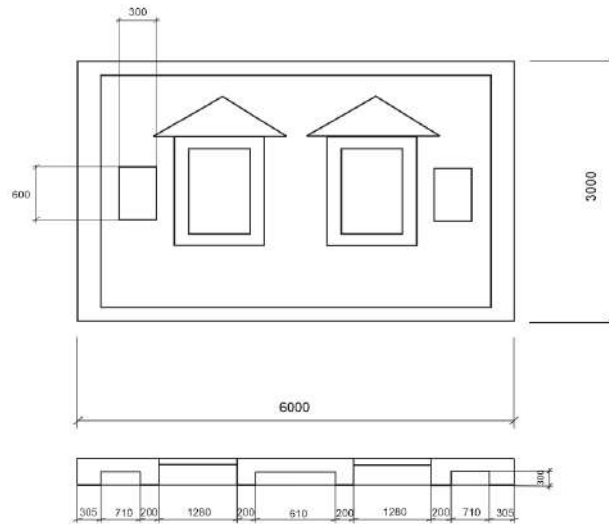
Фасад из стеновой панели серии 1.090.1-1с
